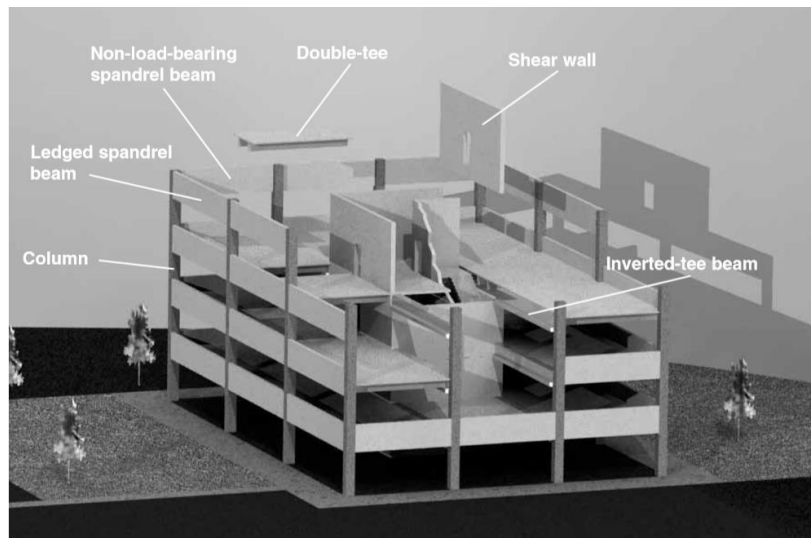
Sistema de Muro de corte interior núcleo [1]
